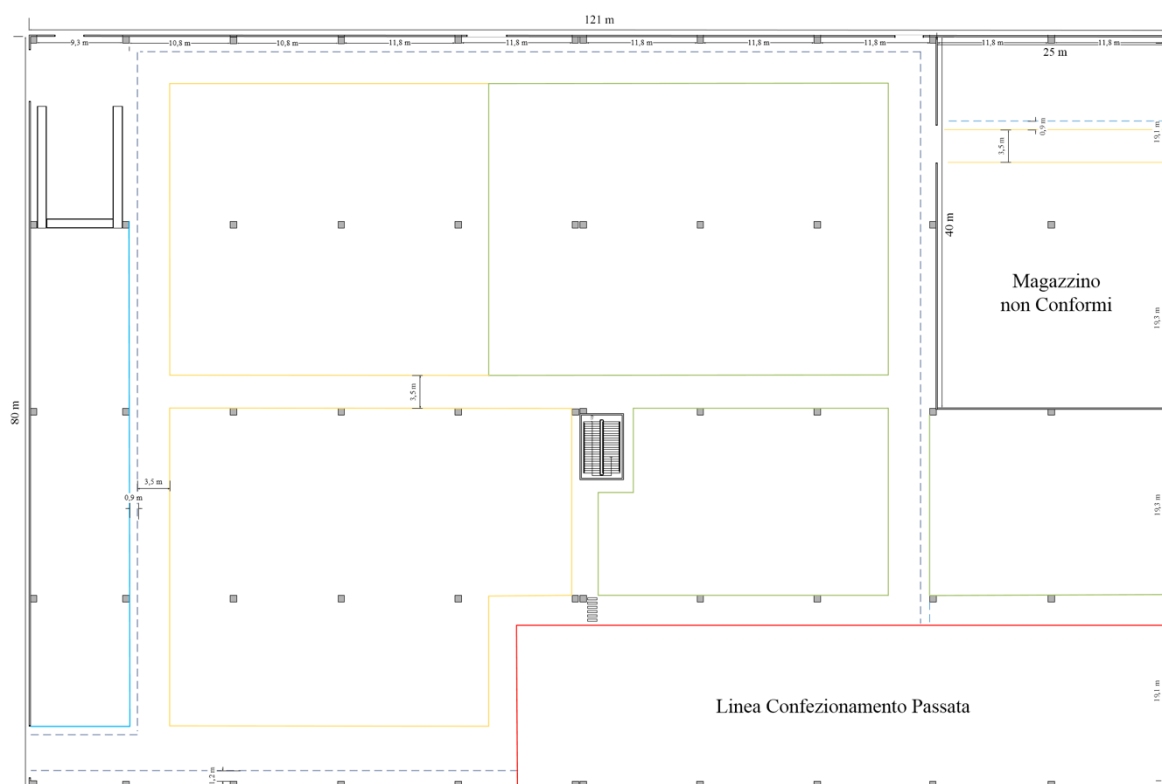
Layout Magazzino Lotto 10 Zone di stoccaggio
